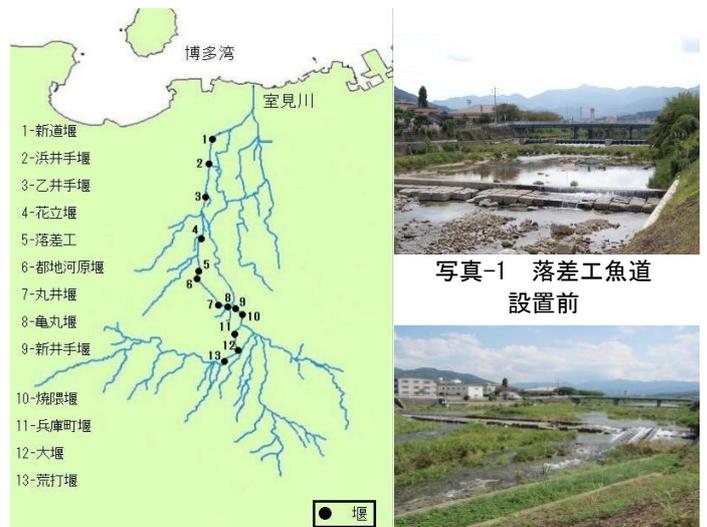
対象とした室見川本川の12の堰の位置と名称 写真-2 落差工魚道設置後
